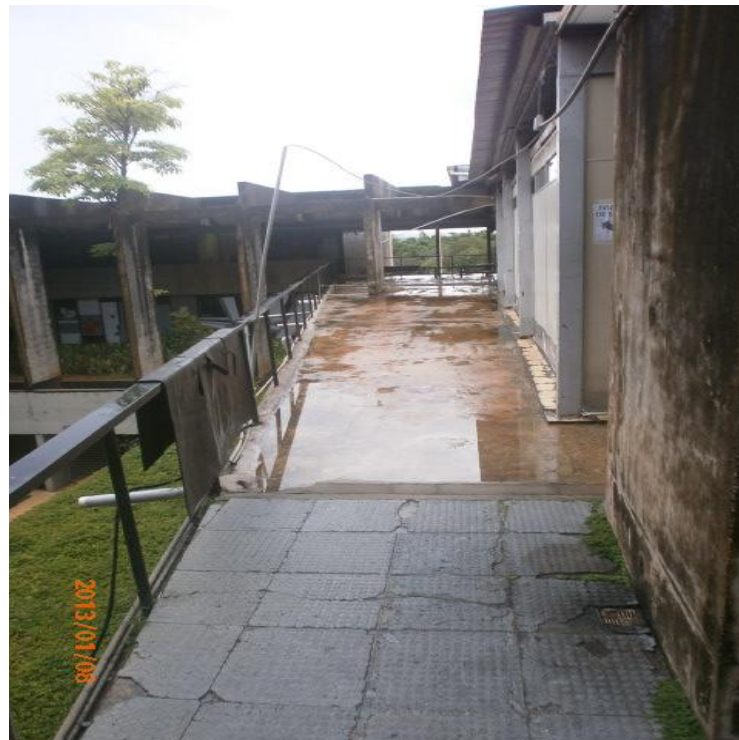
Corredor de acesso entre as ala A e B- 1º pavimento
